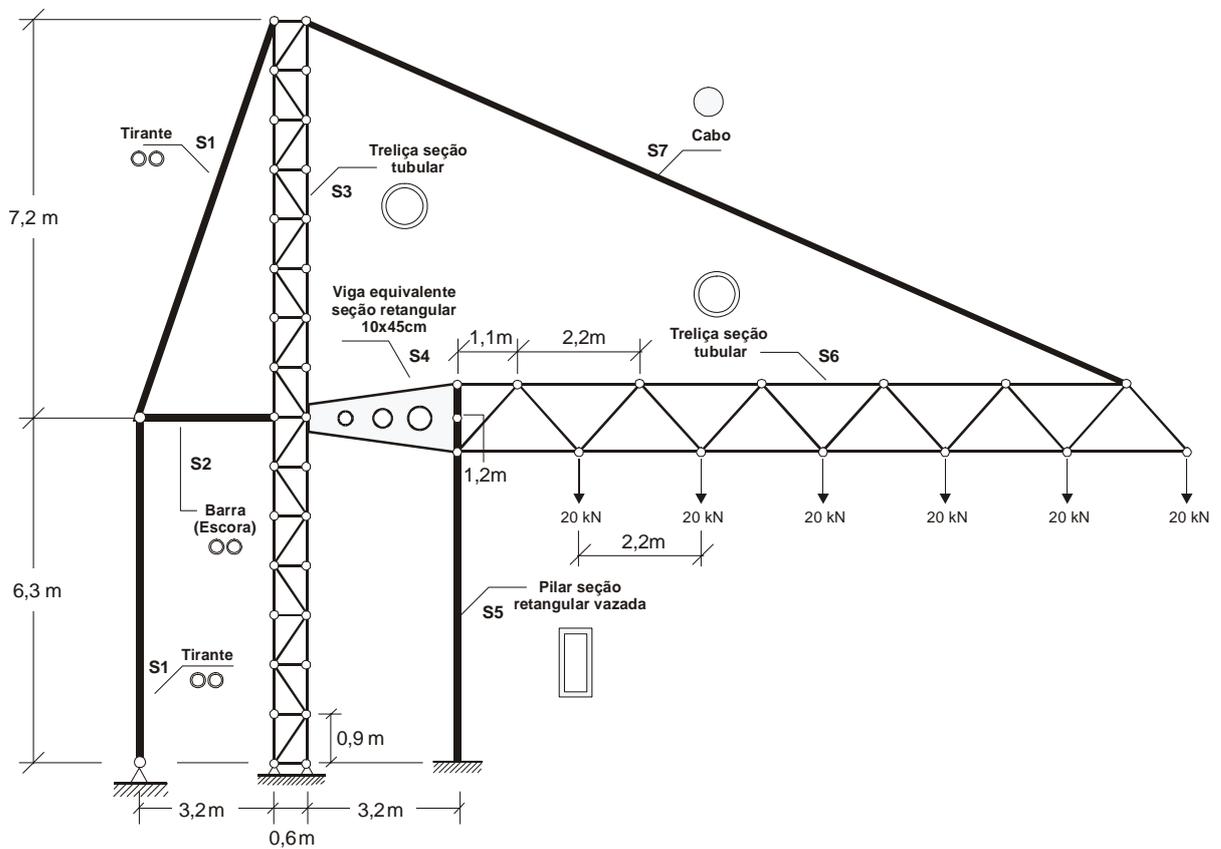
Esquema estático, carregamento devido ao peso da cobertura e tipos de seções e elementos estruturais
